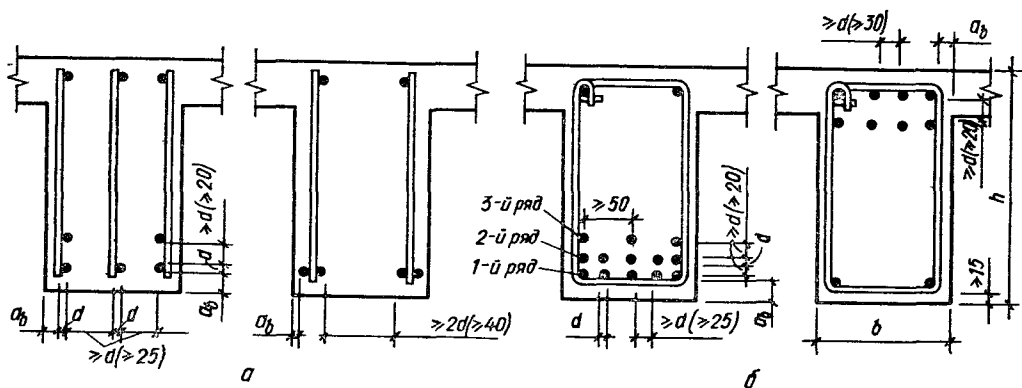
Расположение продольной сварной (а) и вязаной (б) арматуры в поперечном сечении балки.
